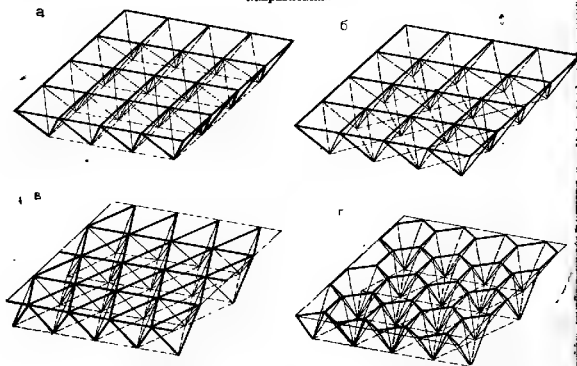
Схемы перекрестно-стержневых конструкций из решетчатых пирамид
